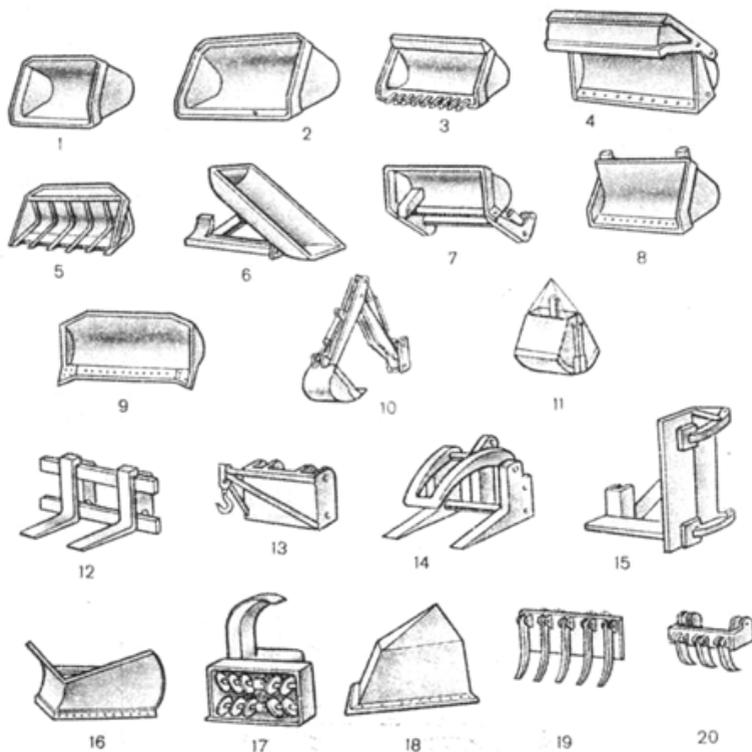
Сменное рабочее и навесное оборудование одноковшовых погрузчиков: 1 – нормальный ковш; 2 – увеличенный ковш; 3 – уменьшенный ковш; 4 – двухчелюстной ковш; 5 – скелетный ковш; 6 – ковш боковой разгрузкой; 7 – ковш с увеличенной высотой разгрузки; 8 – ковш с принудительной разгрузкой; 9 – бульдозерный отвал; 10 – экскаватор; 11 – грейфер; 12 – грузовые вилы; 13 – кран; 14 – челюстной захват; 15 – захват для столбов и свай; 16 – плужный снегоочиститель; 17 – роторный снегоочиститель; 18 – кусторез; 19 – корчеватель-собирающий; 20 – асфальтовзламыватель
